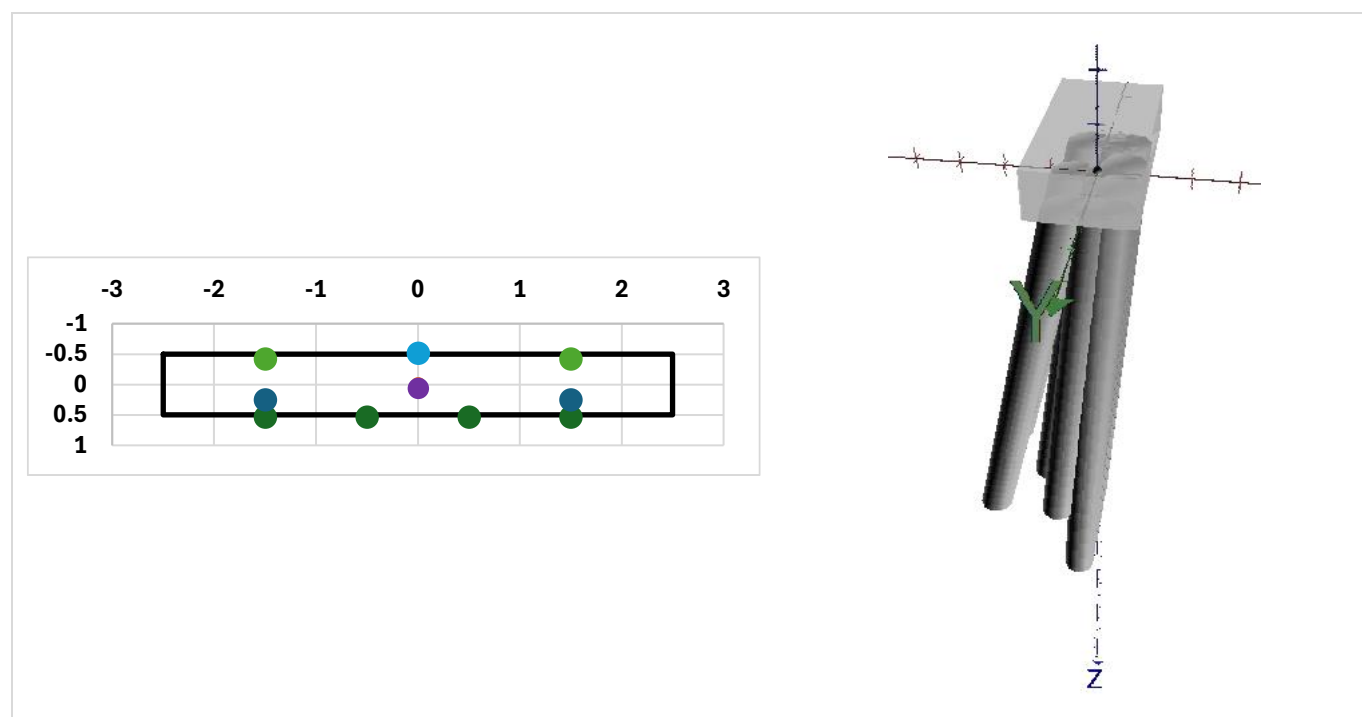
Calepinage des colonnes de jet grouting et modèle de la semelle des fondations N & E (Conciergerie)
